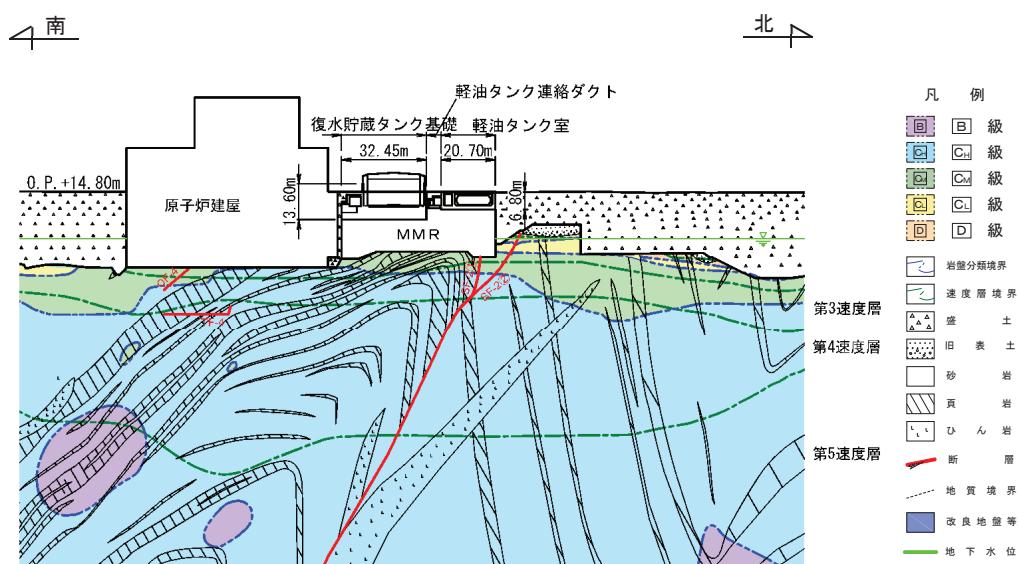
復水貯蔵タンク基礎地質断面図 (A-A)
